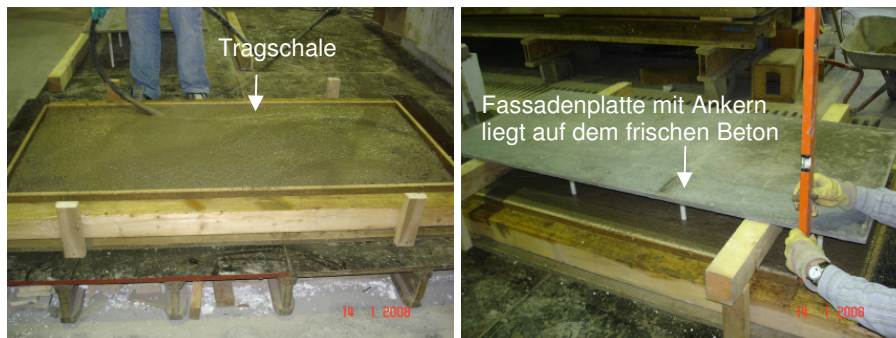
Eintauchen der Fassadenplatte mit Anker in den frischen Beton
